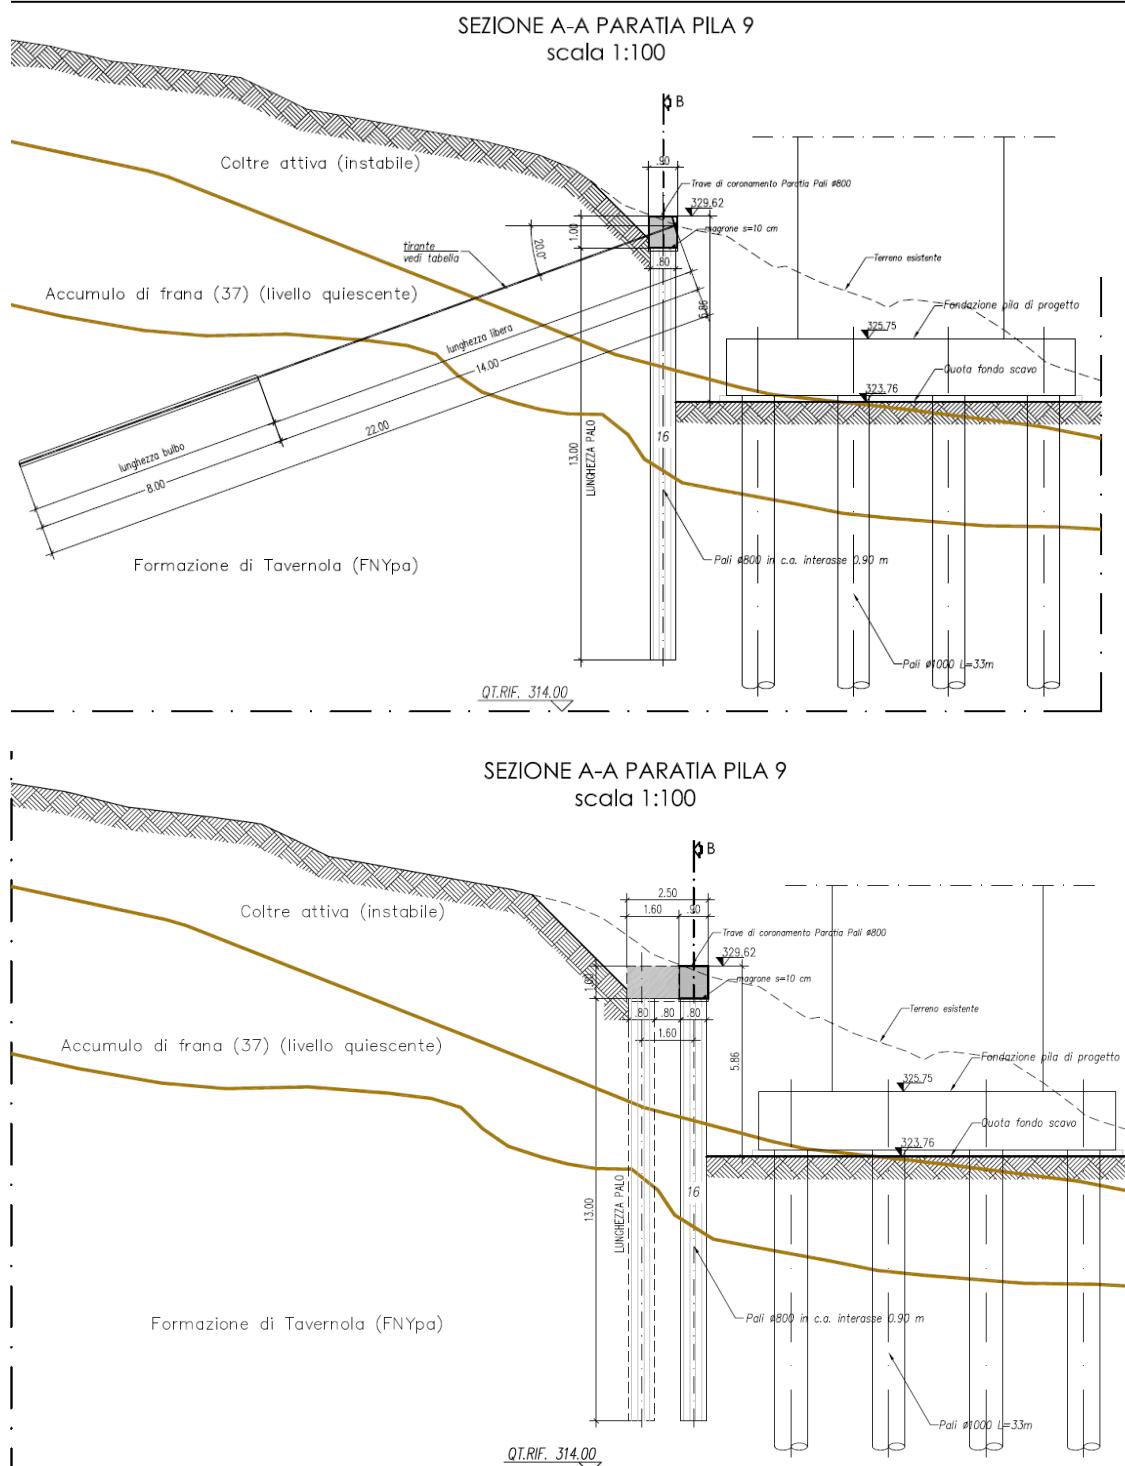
Sezione trasversale paratia provvisionale Pila 9- In alto soluzione di progetto esecutivo in basso proposta di modifica tecnica
